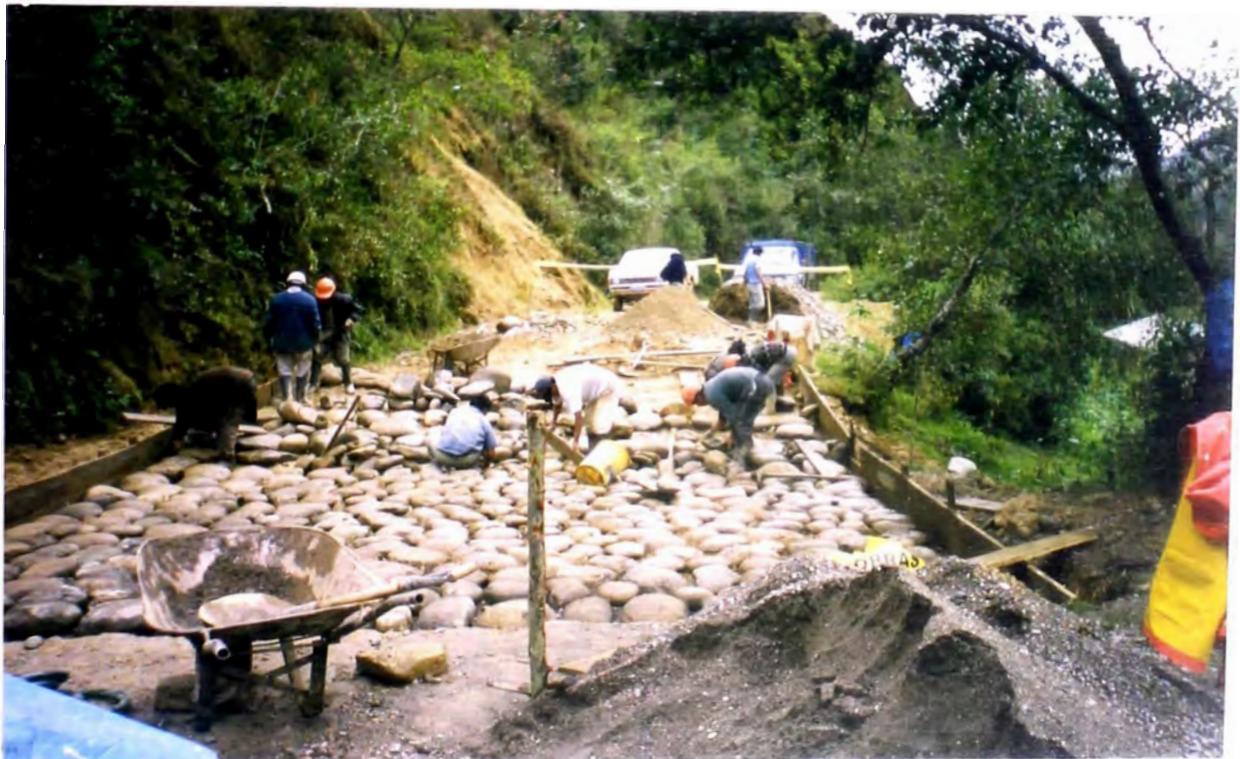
CONSTRUCCIÓN DEL BADEN DE PIEDRA. EL ARMADO ES SIMILAR A UN EMBOQUILLADO
